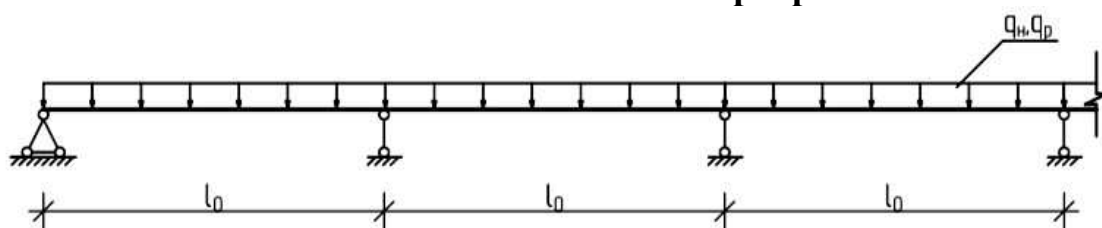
Расчетная схема монолитной плиты перекрытия
